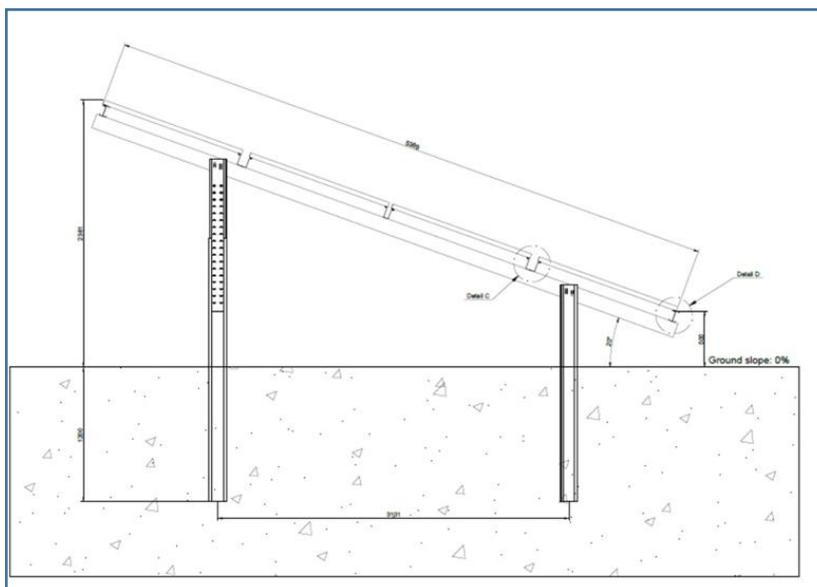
SUPPORTO SU STRUTTURA FISSA
